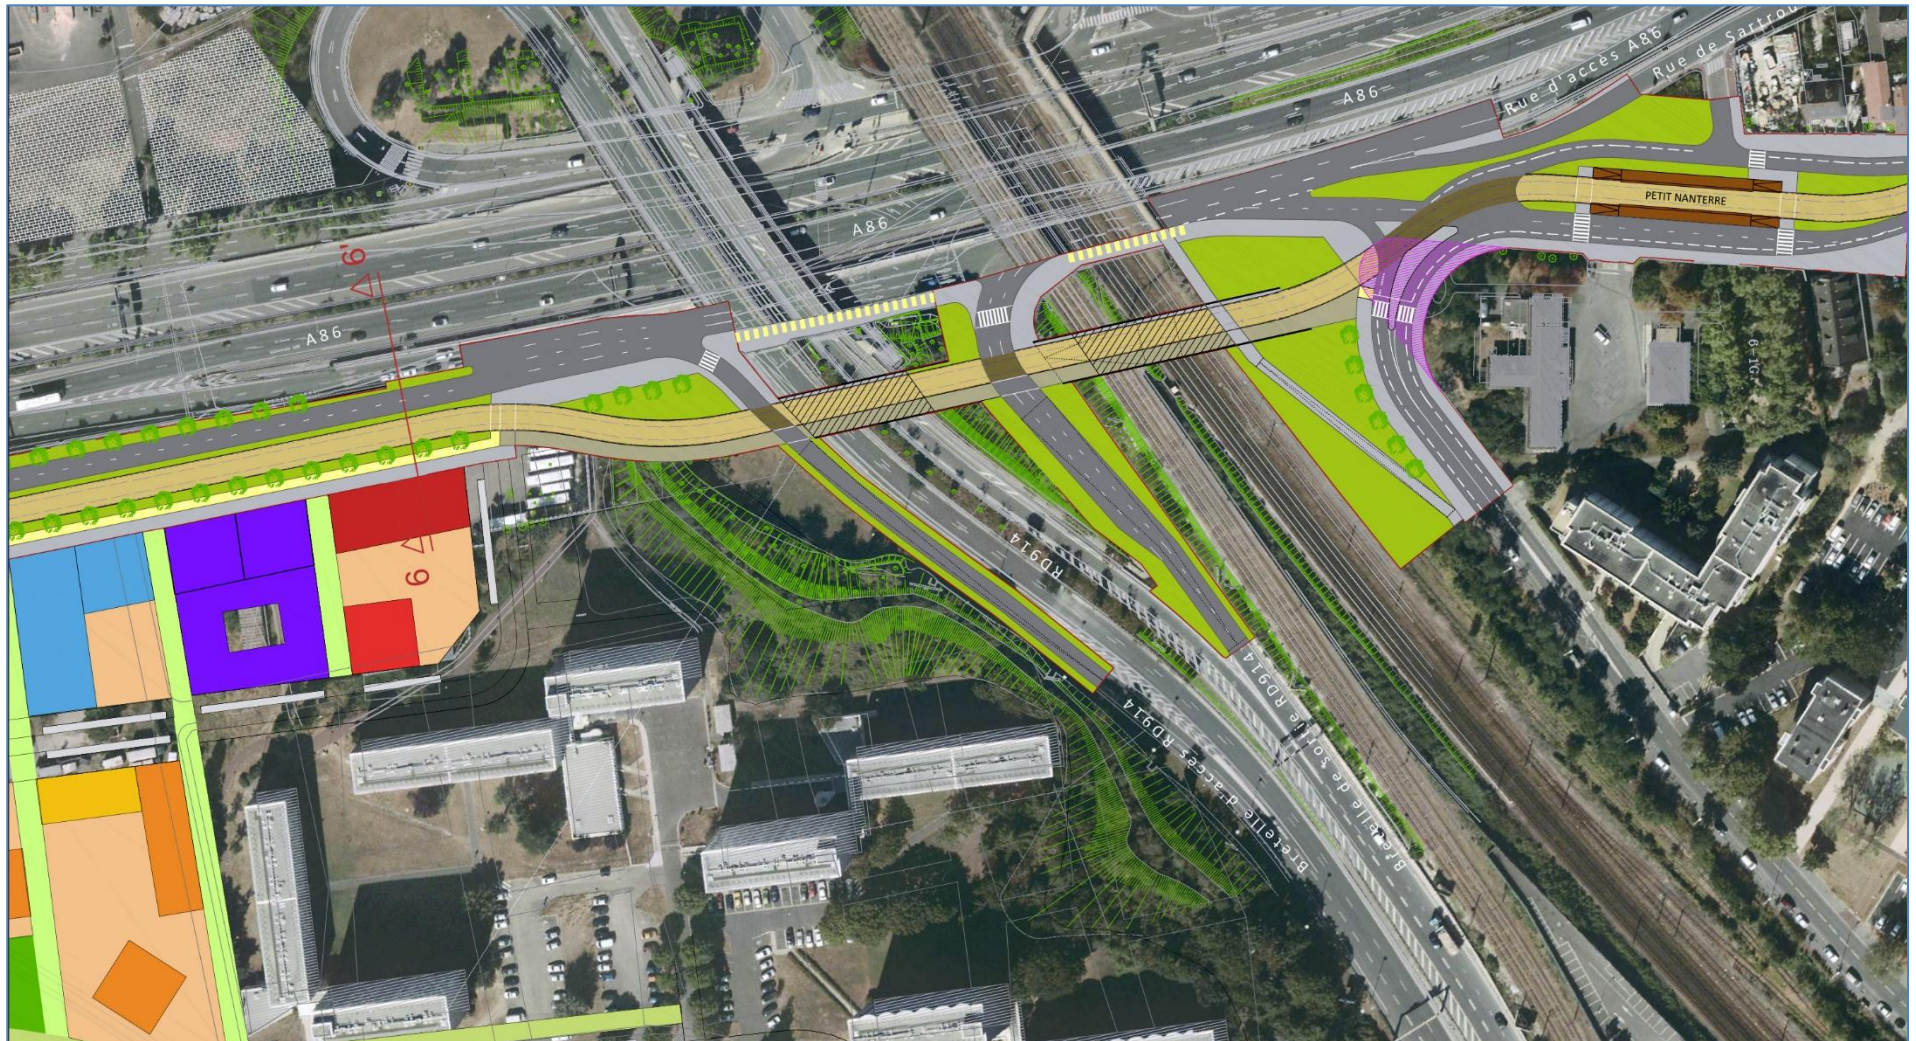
Séquence 1 – section D – Franchissement avec croisement
